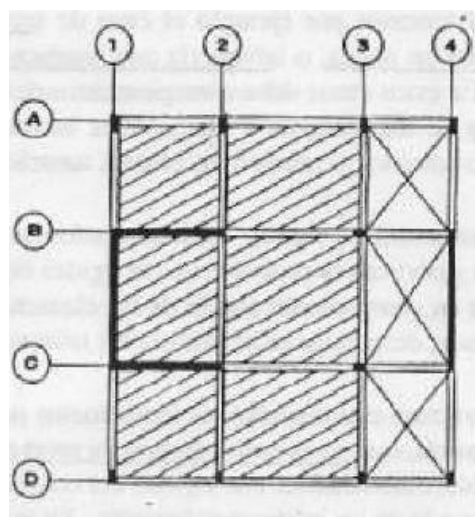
Planta de edificio con simetría aparente, pero con aberturas entre los ejes 3 y 4, por lo cual el eje 4 no recibirá transferencia de carga sísmica.
